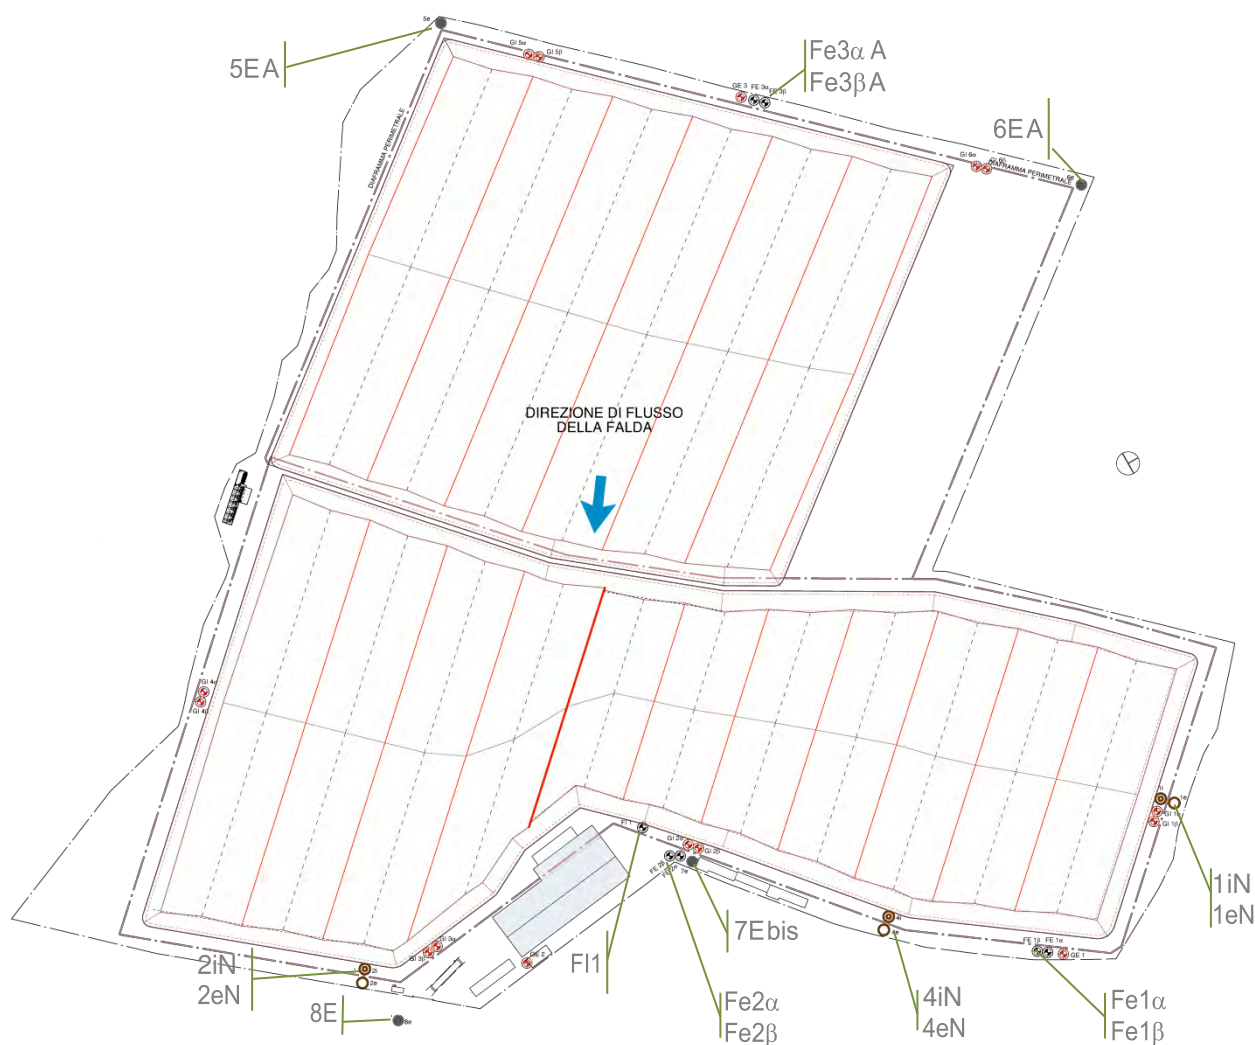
Planimetria pozzi di monitoraggio acque di falda
